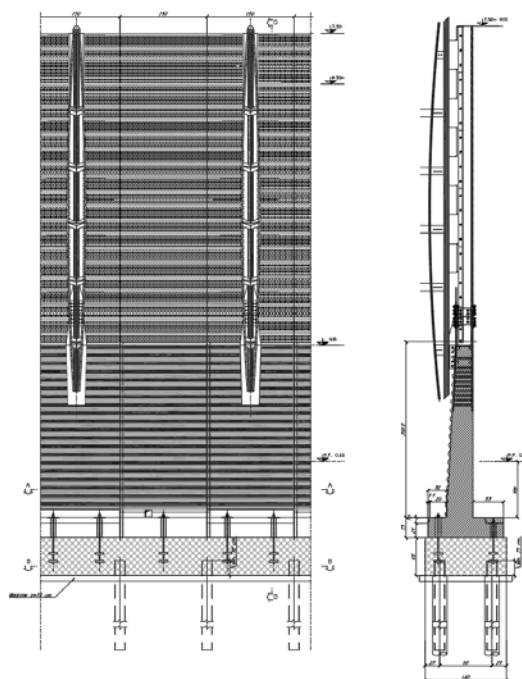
Prospetto e sezione tipo barriera antirumore tipo H10
